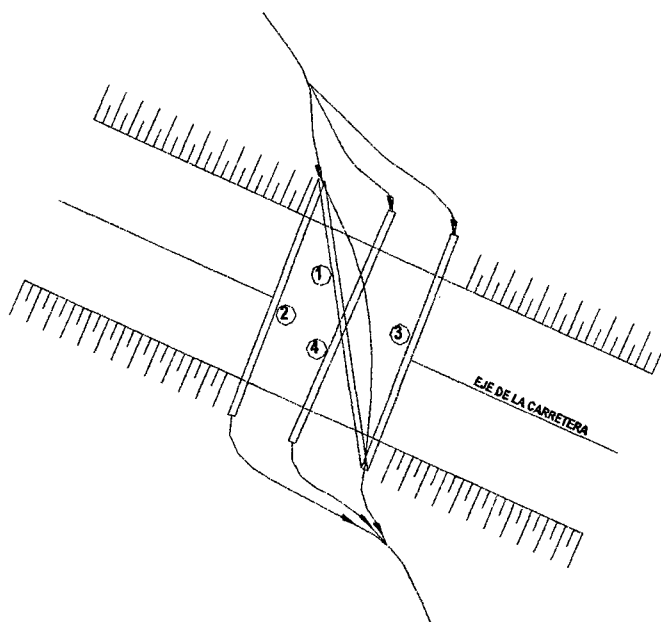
Alineamiento Horizontal de Alcantarilla.
